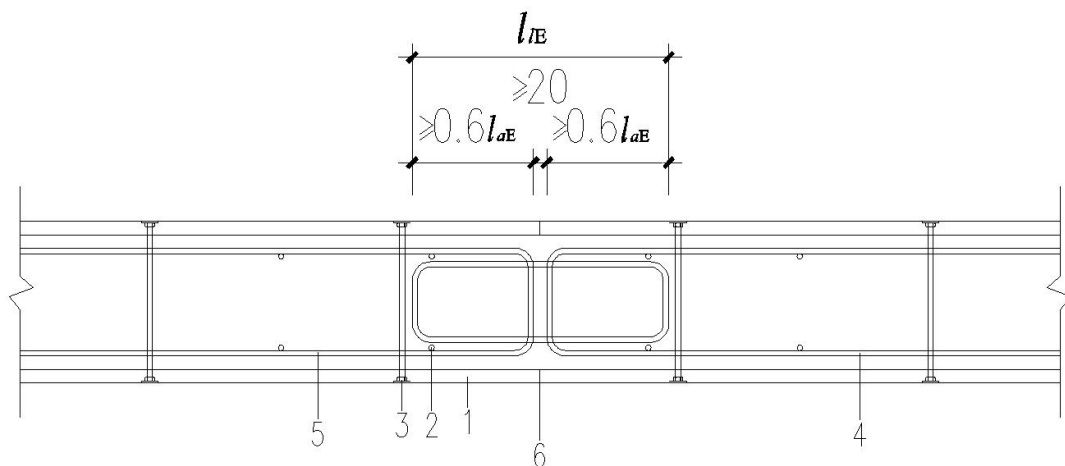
剪力墙边缘构件纵向钢筋连接构造示意
